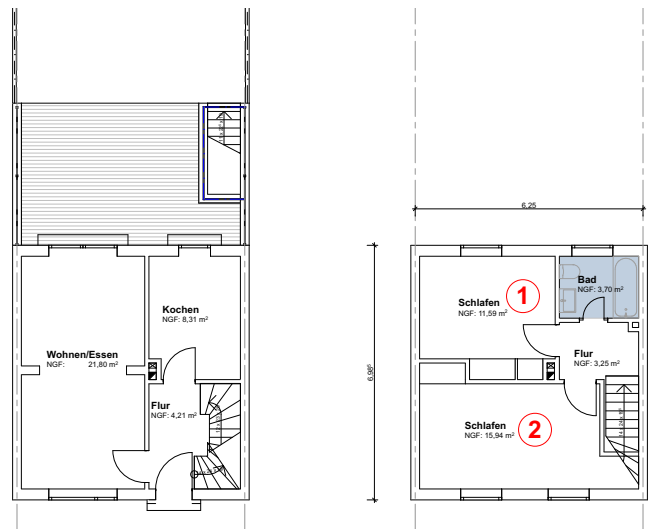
Grundriss Bestand Typ BH 29
